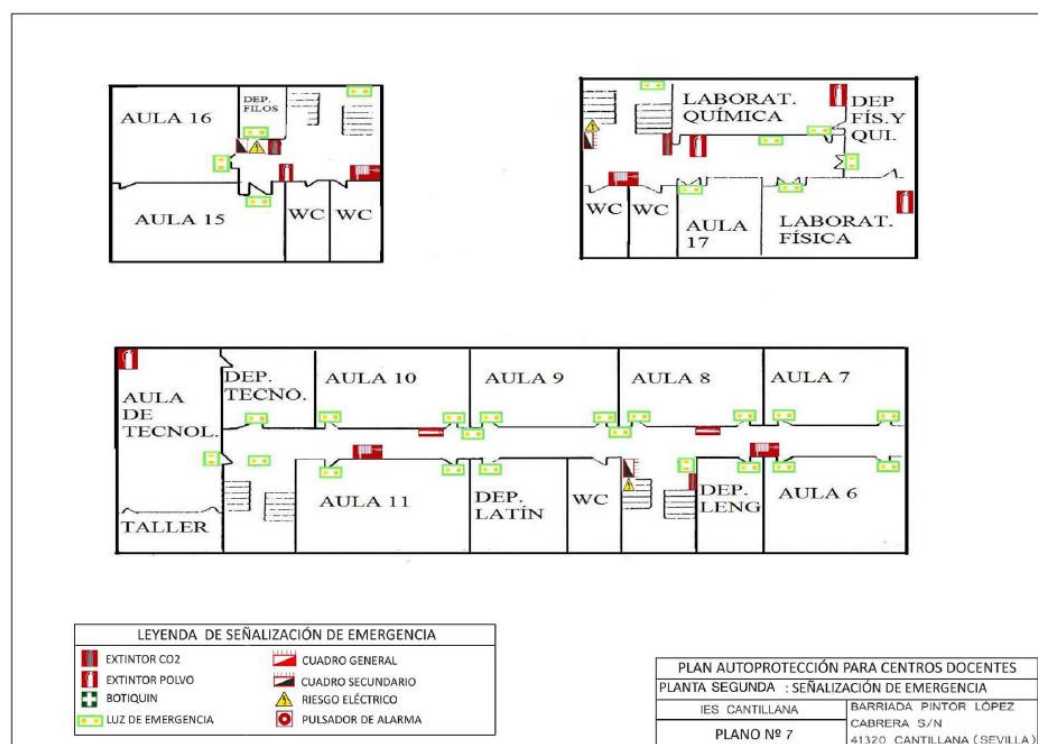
Plano de señalización de emergencia en planta segunda de los edificios 1 y 2 del IES Cantillana.
